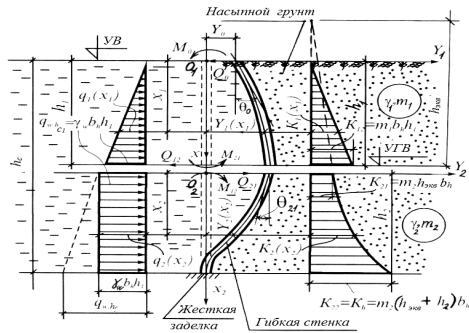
Схема к расчету стенки на горизонтальные нагрузки.
